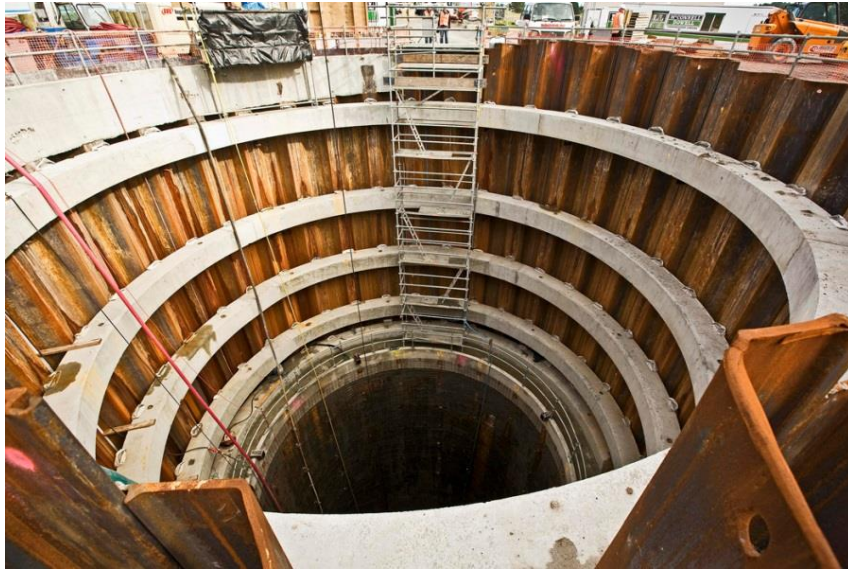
Pique de acceso a túnel de desagüe en proyecto “Rosedale outfall”, en Auckland, Nueva Zelanda. 14m de diámetro y 12m de hincado de tablestacas. Wallis (2009).
